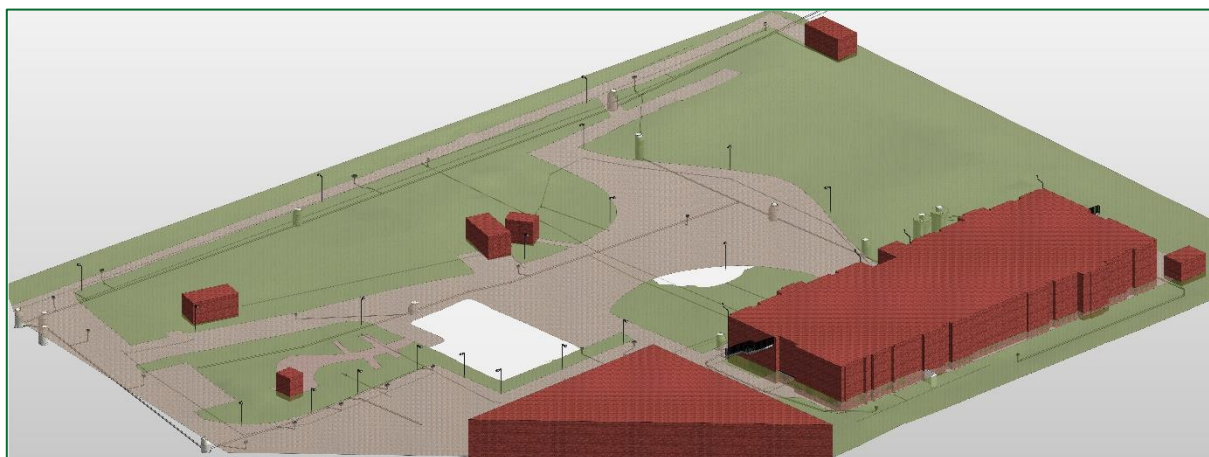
3D Ansicht Außenanlage mit Grundleitungen in Revit
